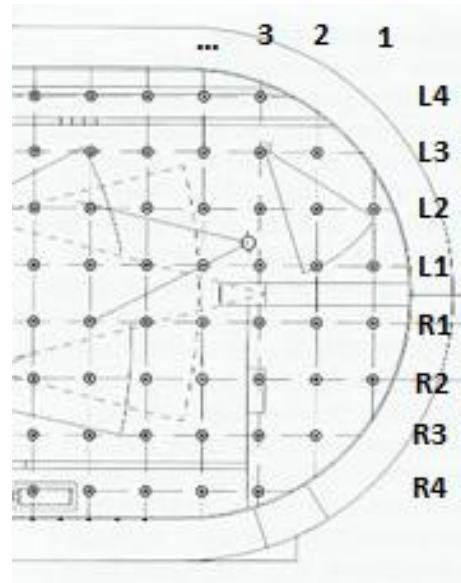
Patroon voor meetpunten op de buitenbaan voor het bepalen van de verlichtingssterkte bij onderhoud
